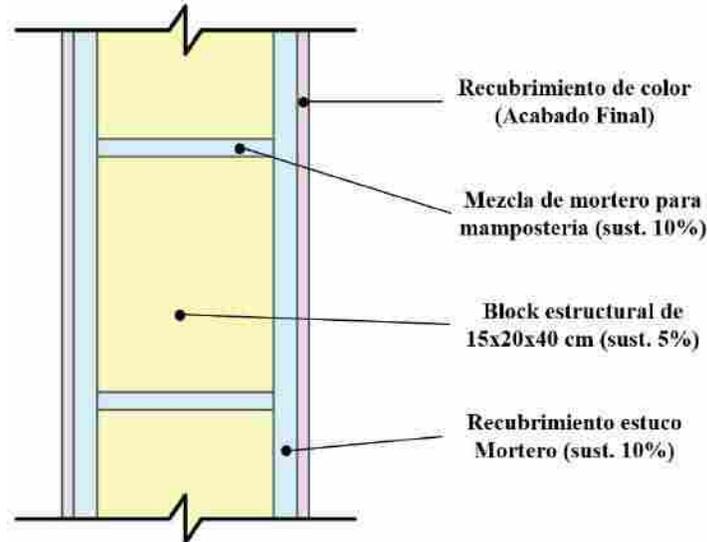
Propuesta constructiva (Fuente: Elaboración propia)
